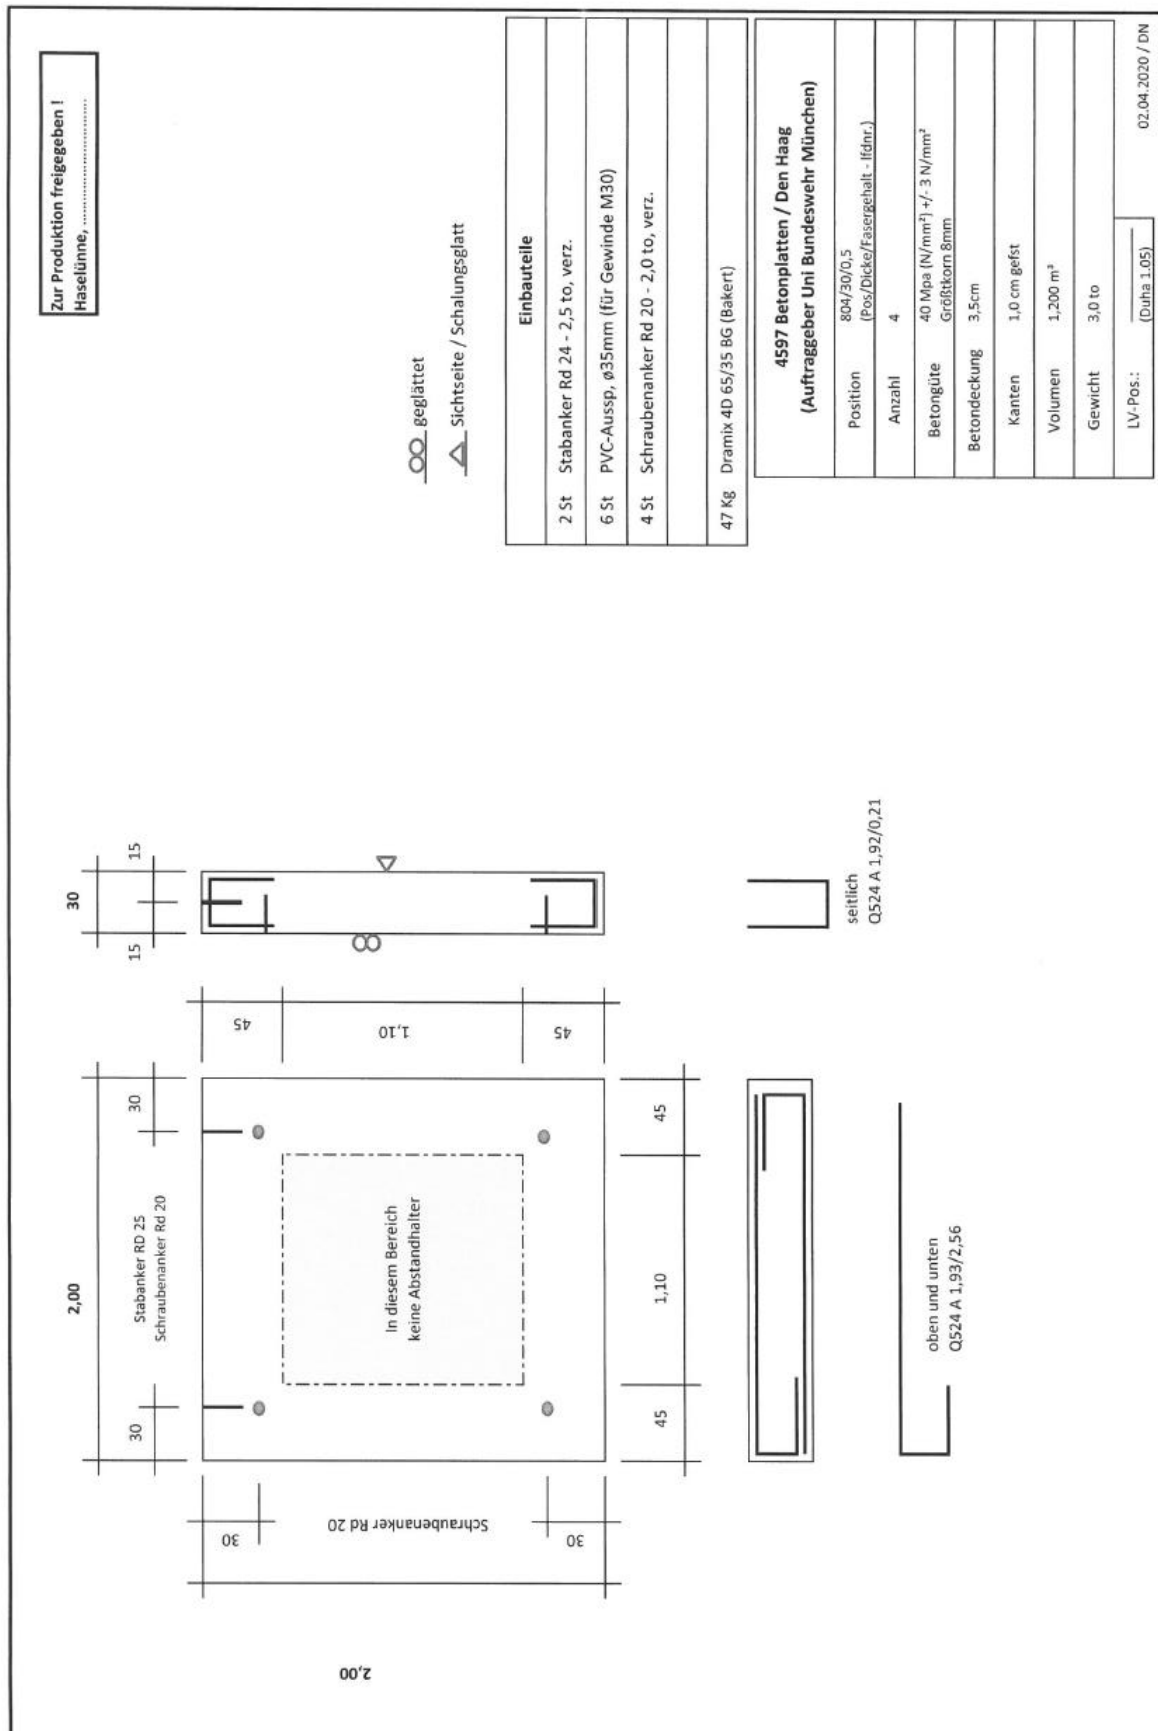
Bewehrungsplan für Stahlfaserbetonplatte mit 0,5 Vol.-% Fasergehalt.
